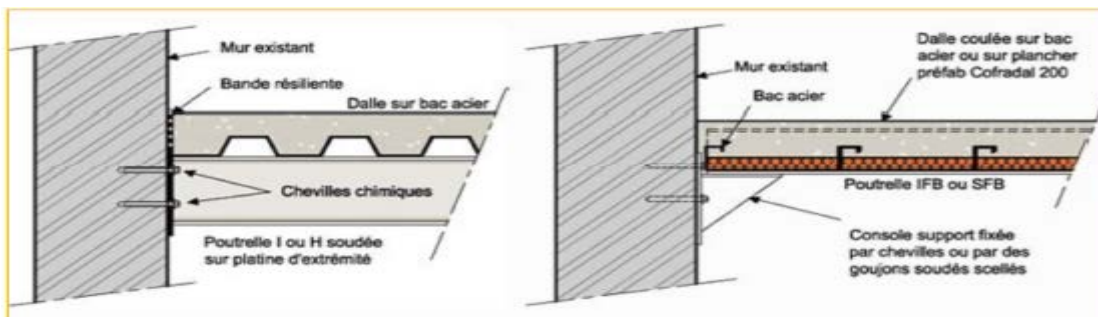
Détail d'articulation entre plancher collaborant et mur
